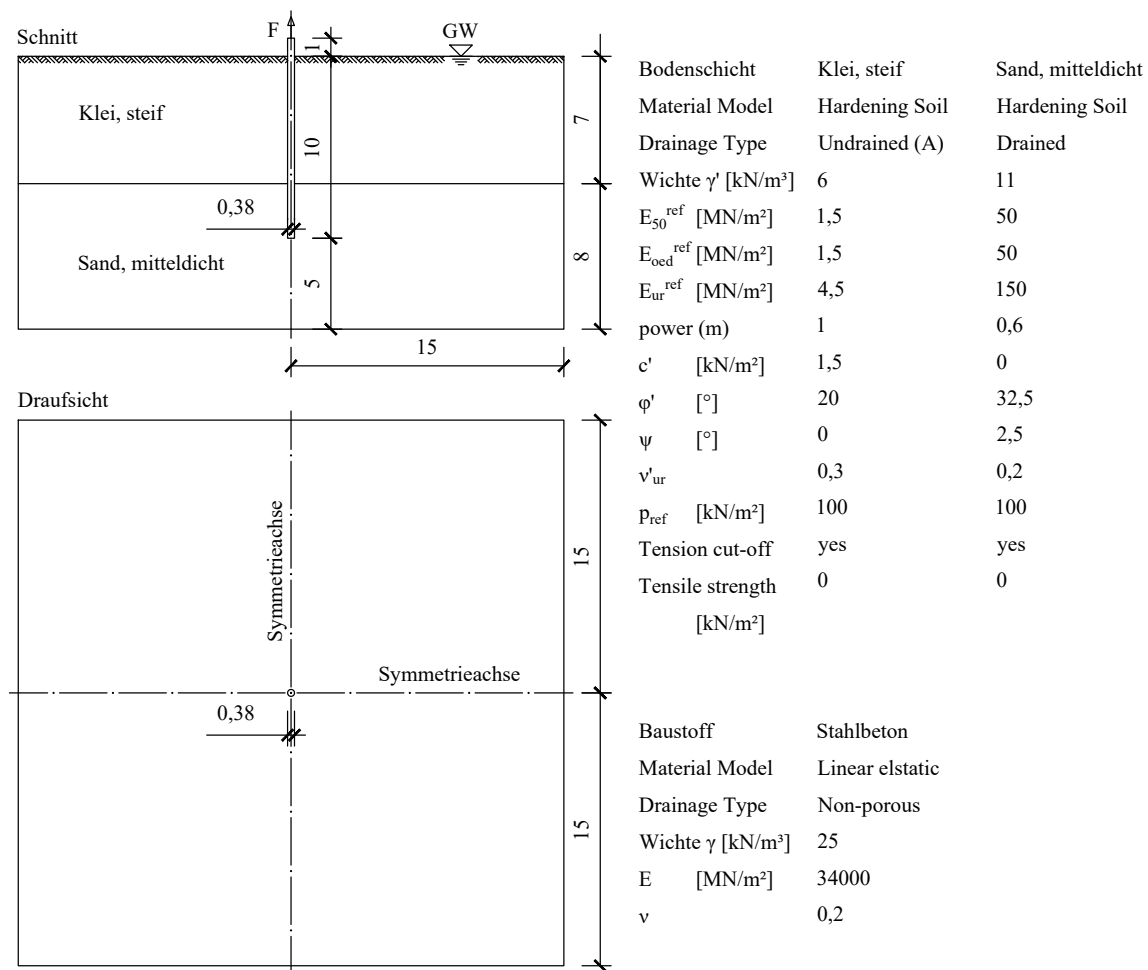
Baugrundschnitt sowie Grundriss des Berechnungsmodells mit den jeweiligen Parametern, Symmetrieachsen sind die Punkt-Strich-Linien gekennzeichnet, Maßangaben in Metern
